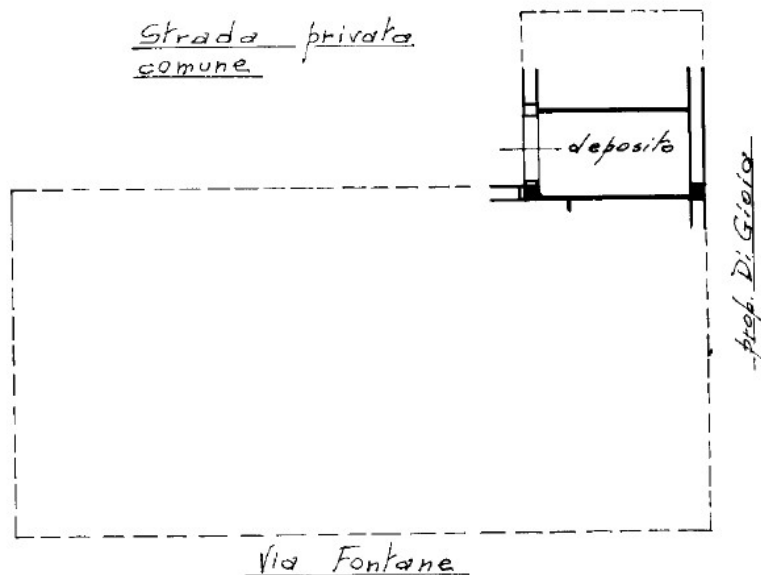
Planimetria del locale box a pianterreno ubicato in via Fontane senza numero civico.
